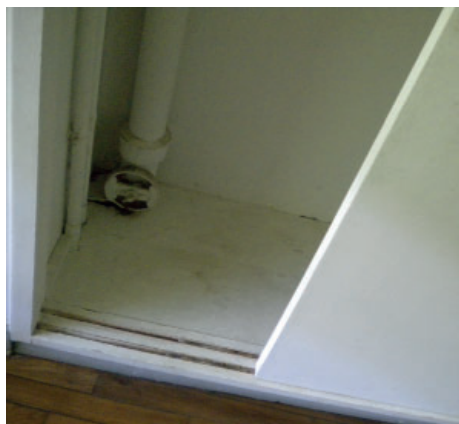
Bajante en el armario de un dormitorio de la planta baja de la Villa Savoye. Fotografía del autor.
